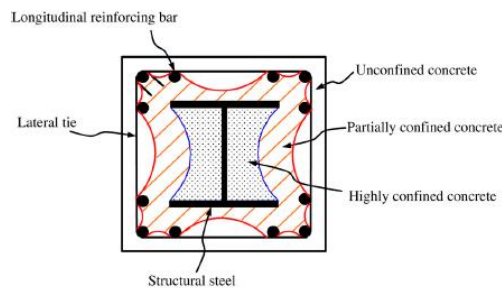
Materiales en una sección mixta de acero embebido en hormigón (Chen y Lin, 2006).
